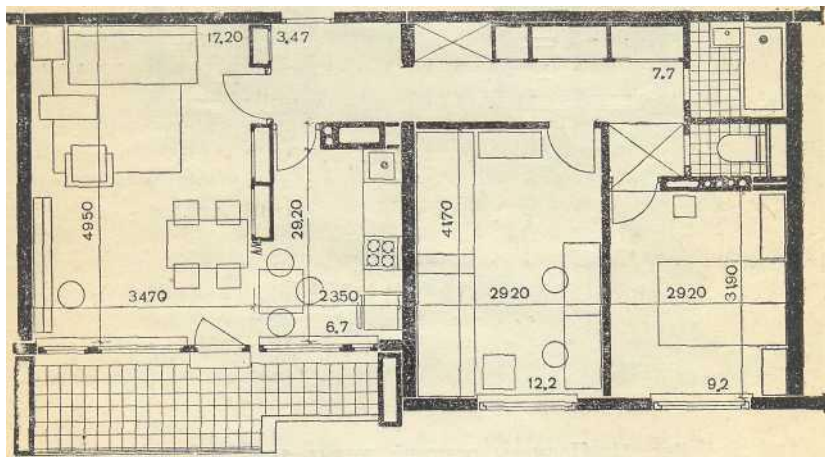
Планировка 3-комнатной квартиры в 16-этажном крупнопанельном доме серии П-60.
